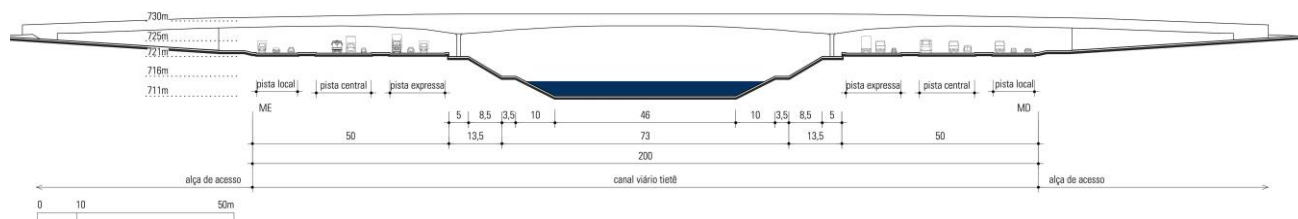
Canal Viário Tietê: seção típica e elevação longitudinal ponte viária existente. Elaboração própria.
